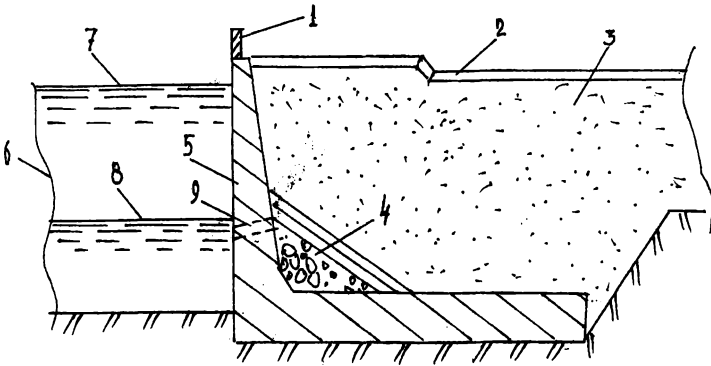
Набережная углового типа из сборных железобетонных панелей:
